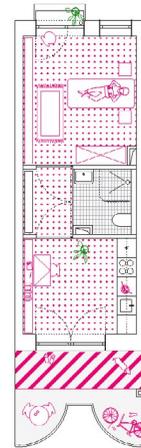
Grundriss Zweizimmerwohnung | Heide & von Beckerath (Berlin)
